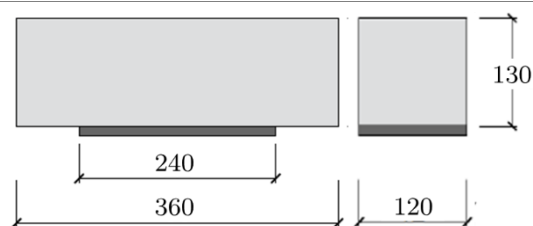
Geometría de las vigas ensayadas y posición del refuerzo.
